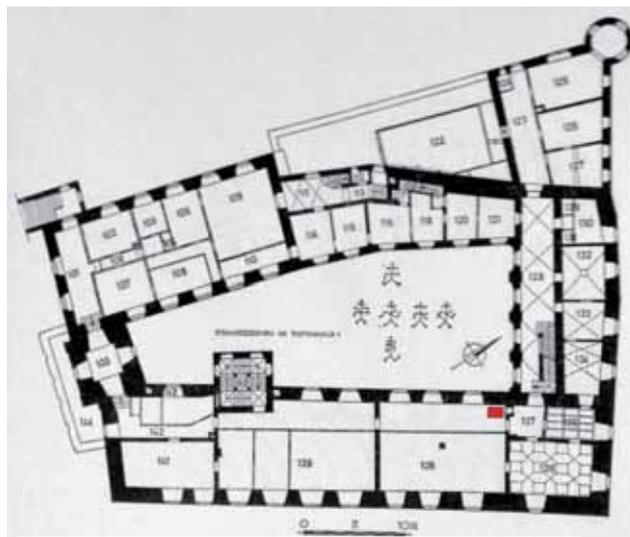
Grundriss 1.OG (HOJER, 1976, S. 285.)
